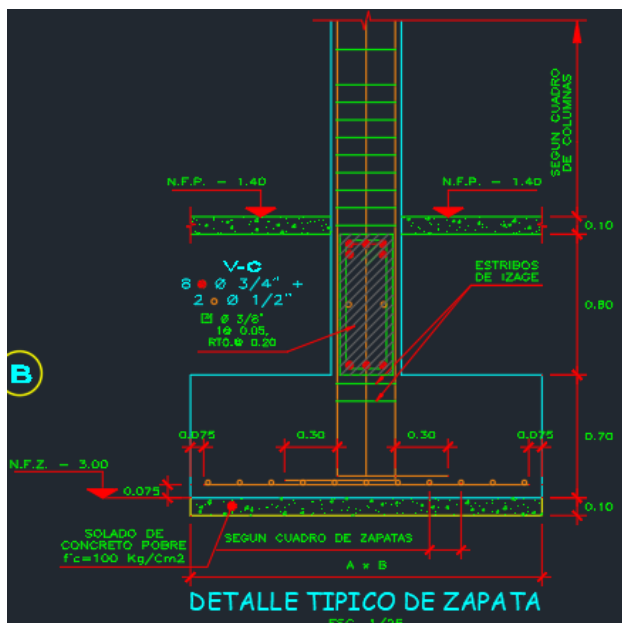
Detalle de Zapata (Fuente: Arconsa Contratistas Generales, 2018).
